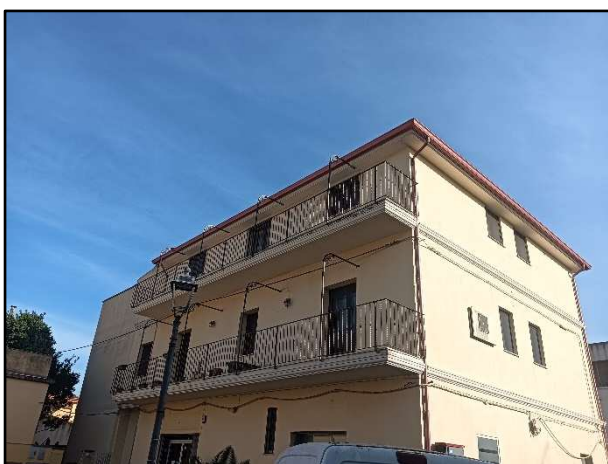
Prospetti Piazza Ungheria – Vista sud-ovest
